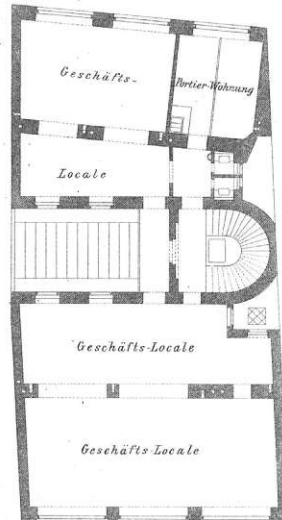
Grundrisse Rotenturmstraße 7 - Ludwig Tischler, 1894
